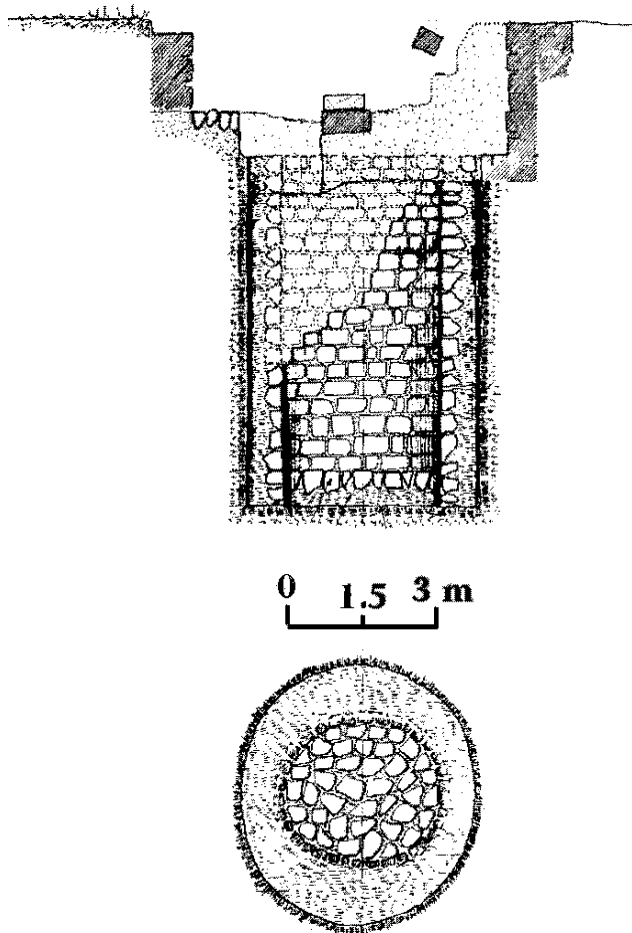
Pianta e sezione della cisterna del tempio "A"
